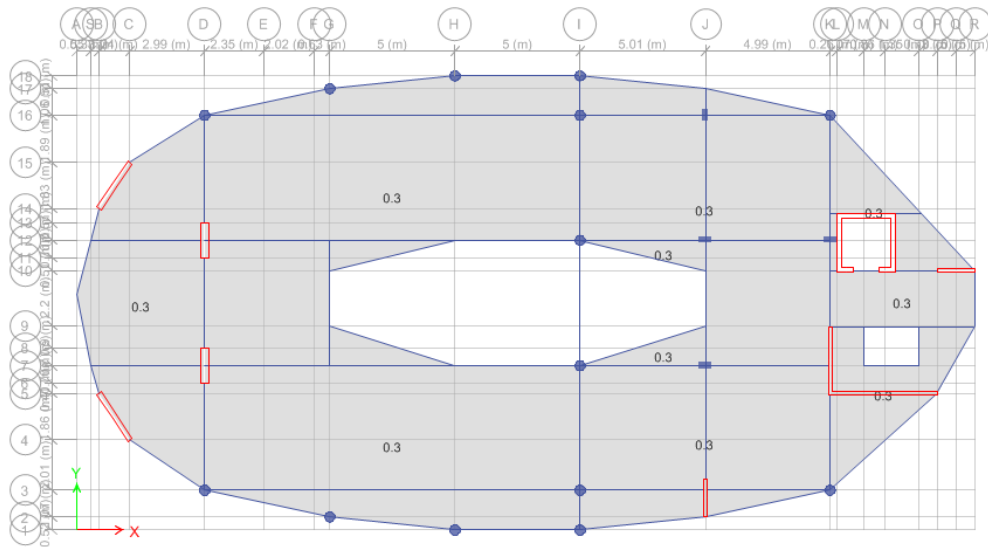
Carga viva colocada sobre el 3er piso del Bloque 1 (GYM)
